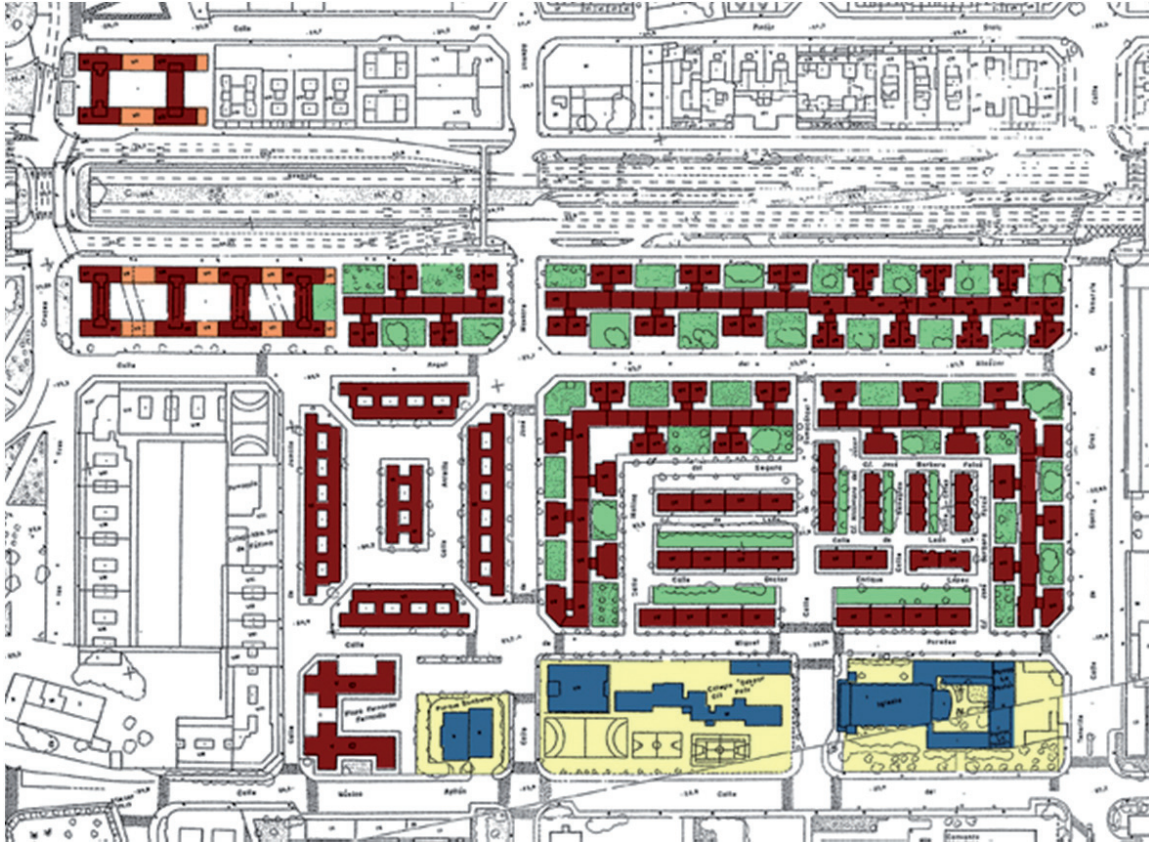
Grupo Virgen de los Desamparados. Plano de conjunto. (En rojo las viviendas, en azul los equipamientos)
